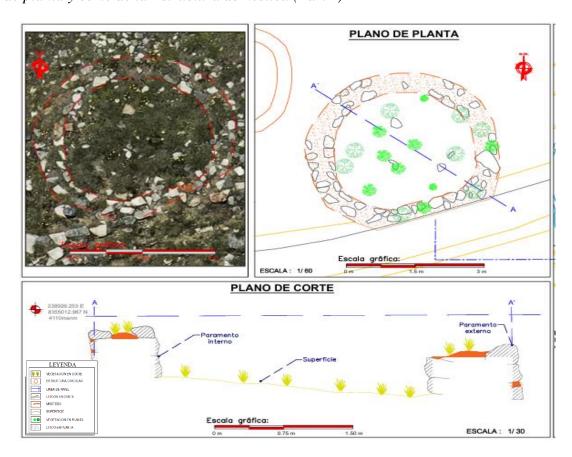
Dibujo de planta y corte de la Estructura domestica (Ed-43
